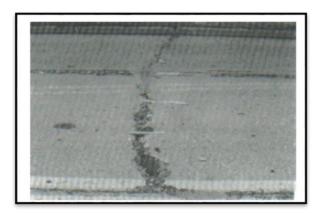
Grietas lineales de severidad alta en losa de concreto simple
